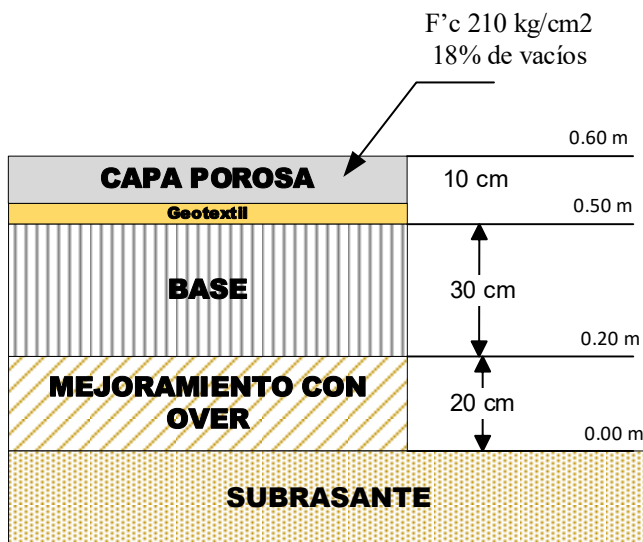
Estructura Final de pavimento peatonal pasaje Teófilo Idrogo
